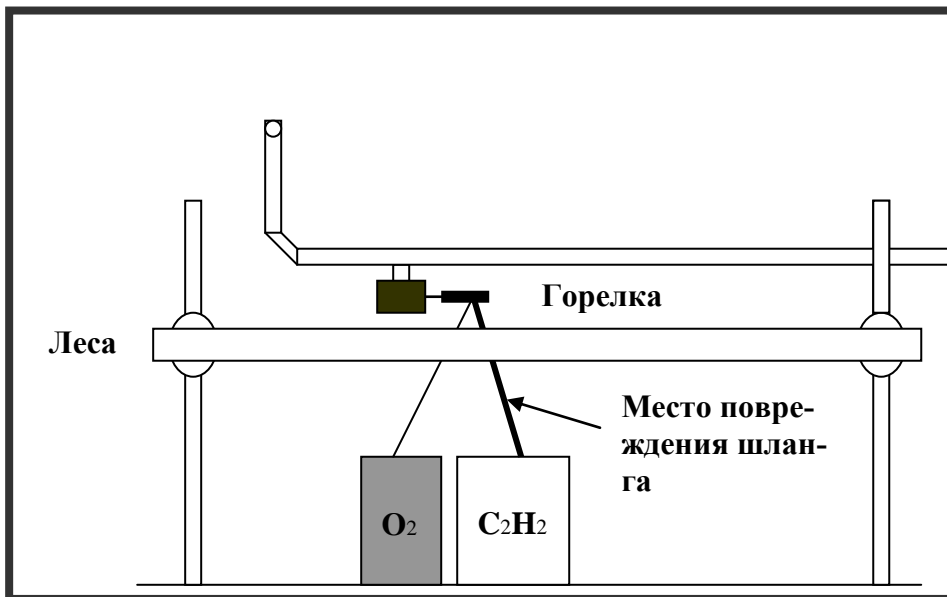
Утечка газа, используемого при сварке
